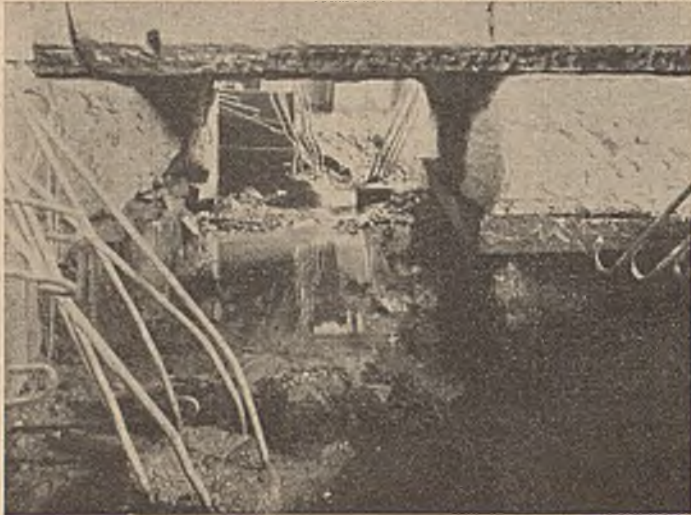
Pfeilerdurchbruch für ein Querbankett.
